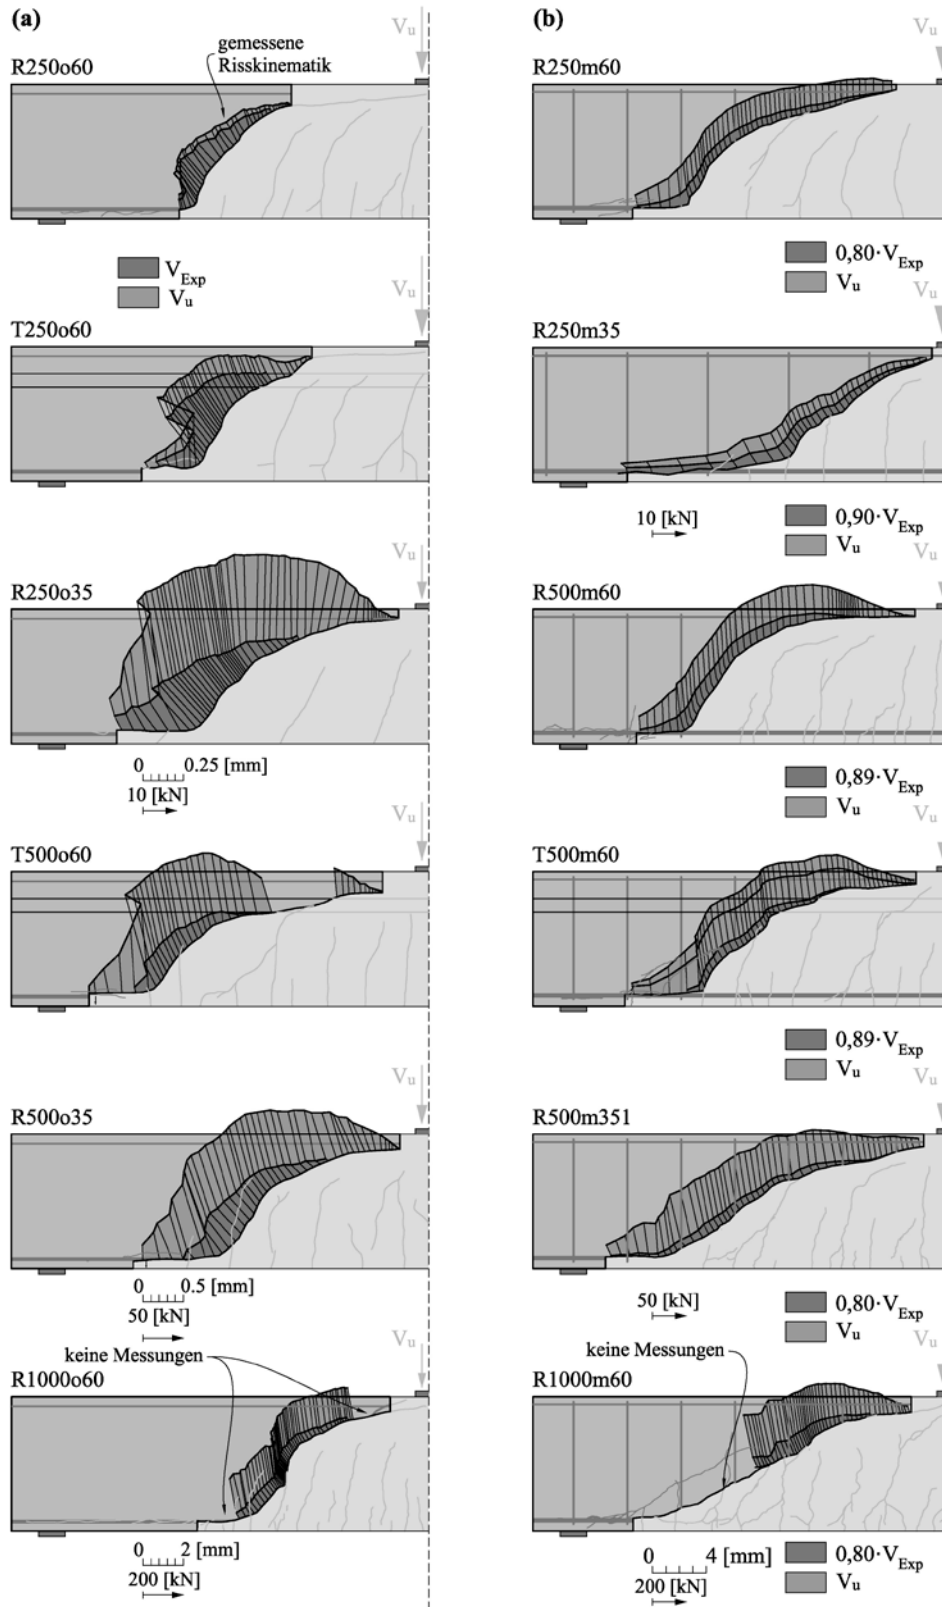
Gemessene Risskinematik für ausgewählte Querkraftversuche: (a) Stahlbetonträger ohne Querkraftbewehrung (b) Stahlbetonträger mit geringer Querkraftbewehrung
